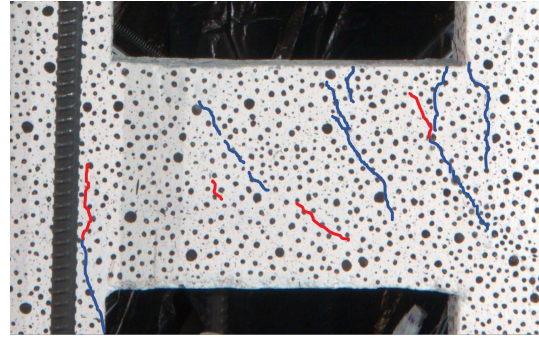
Grietas Vigas a 0.4 % Drift
